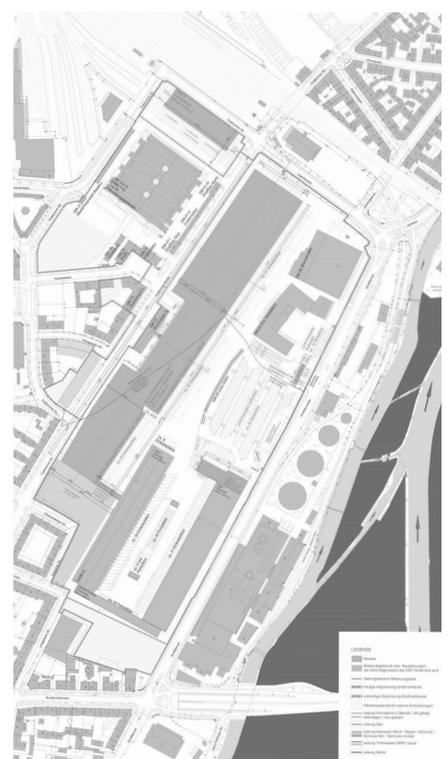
Der Plan zeigt die geplante Bebauung mit der neuen Halle von Ackermann Architekten. (Grauer Riegel, Bild Mitte)
